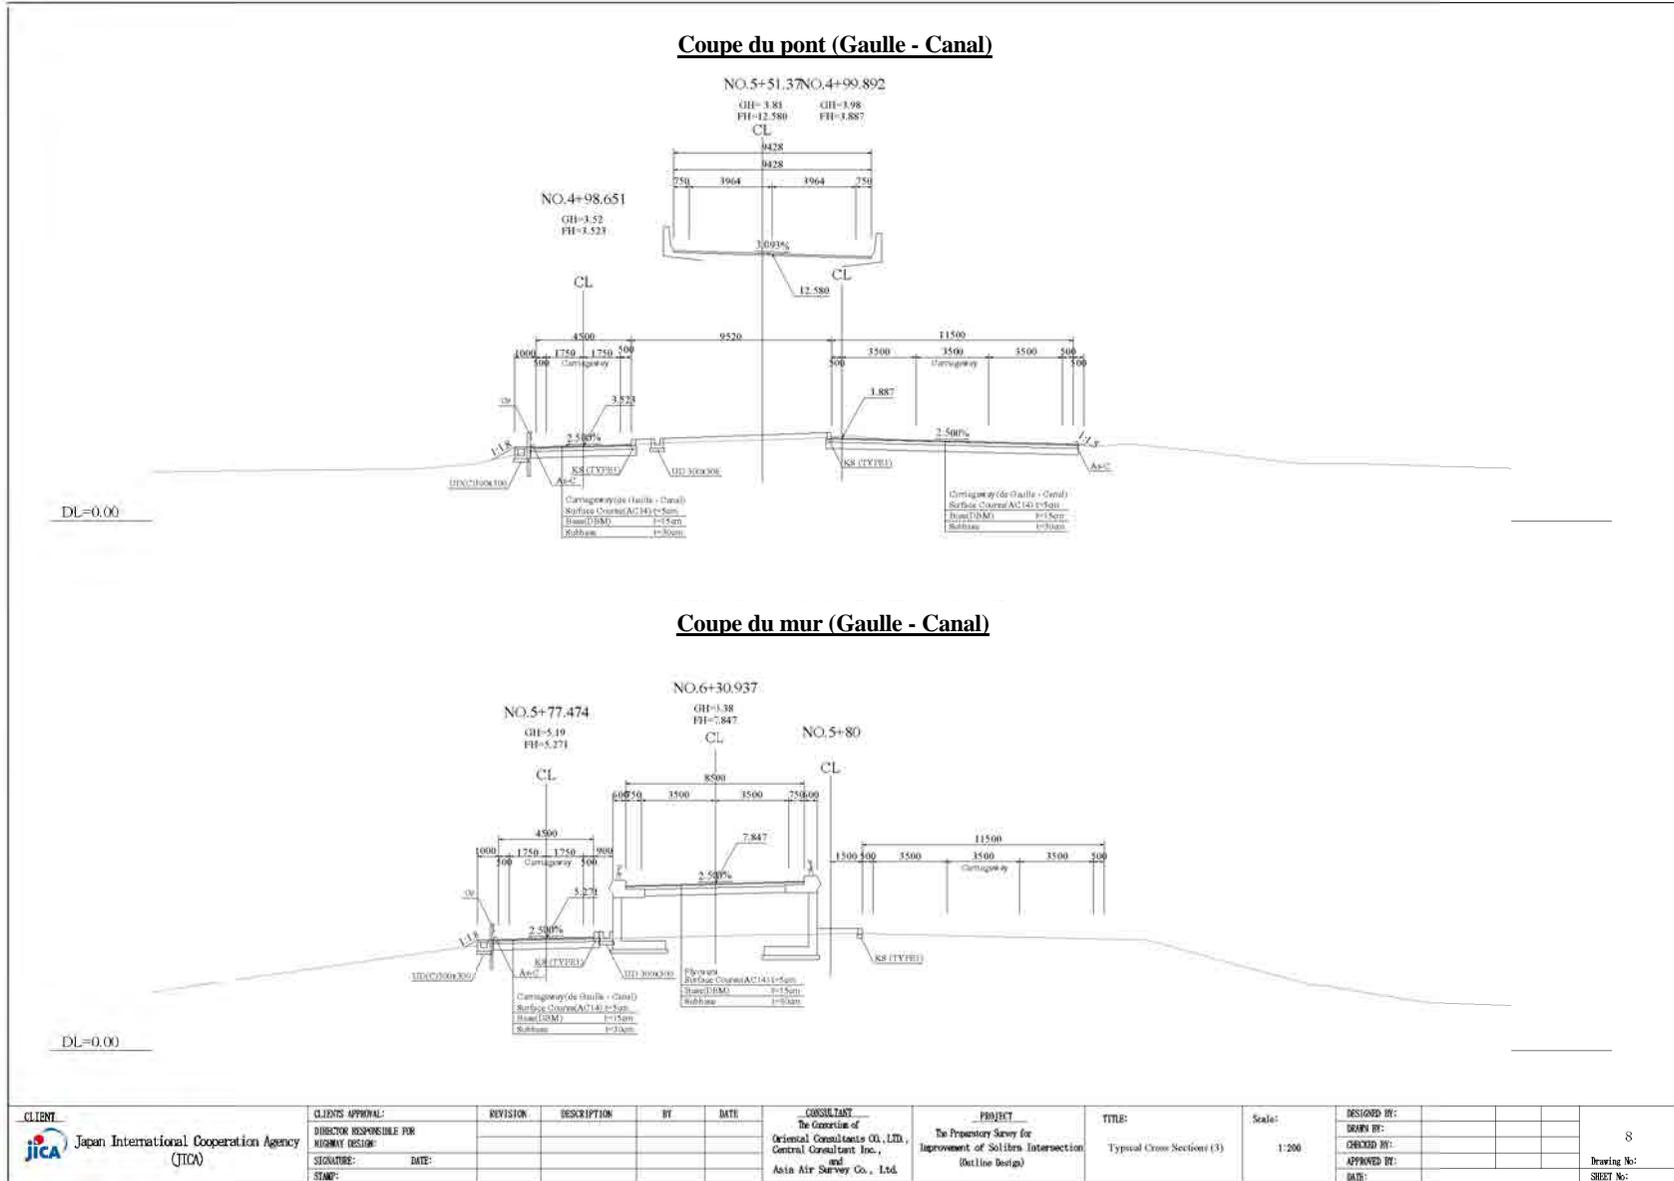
Coupe transversale type (Bld. de Gaulle ; pont / mur de soutènement)
